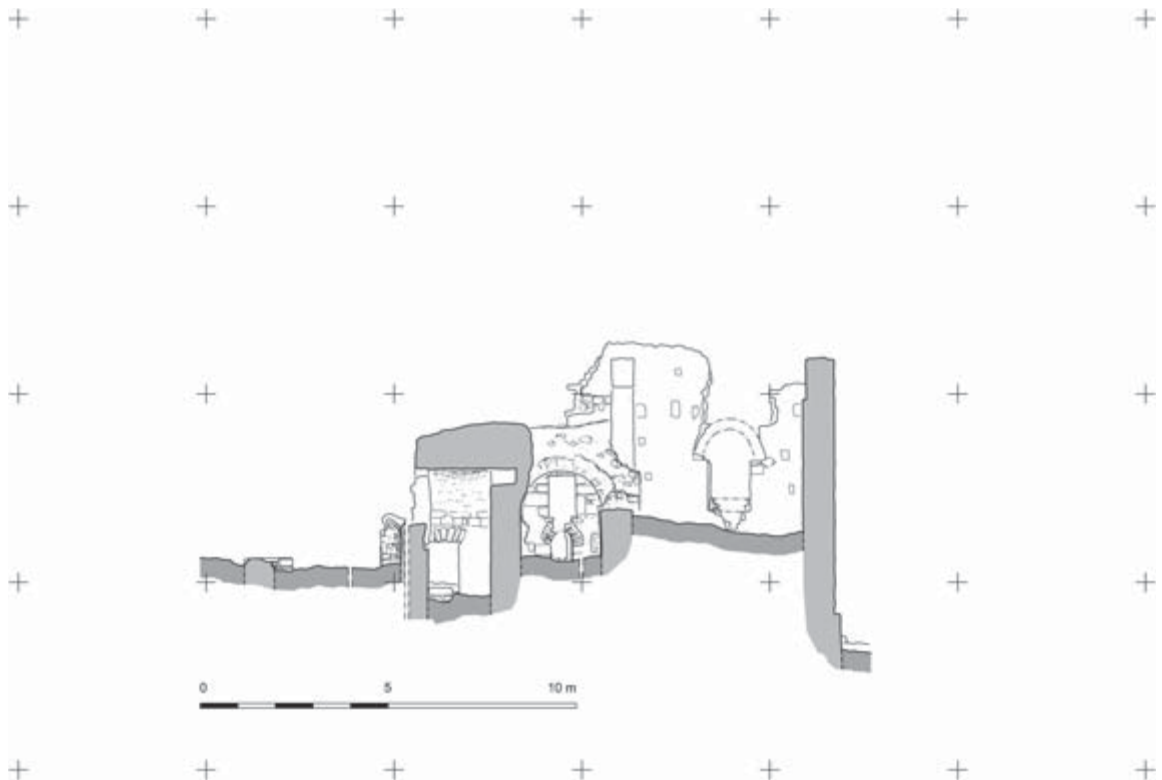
Kirse Yanı, Bauaufnahme, Querschnitt QQ nach Westen
